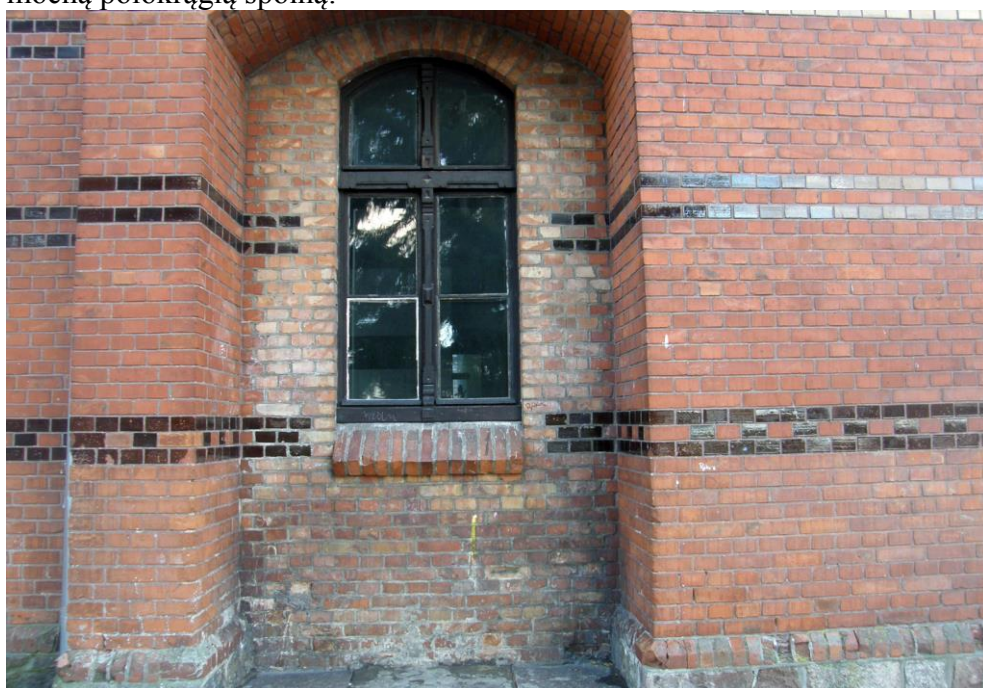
Elewacja południowa; widok ogólny, stan zachowania, miejscowe wtórne przemurowania elewacji ceglanej. Wszystkie zewnętrzne parapety historycznej stolarki okiennej wykonane z cegieł i kształtek glazurowanych w kolorze ciemno brązowym.
